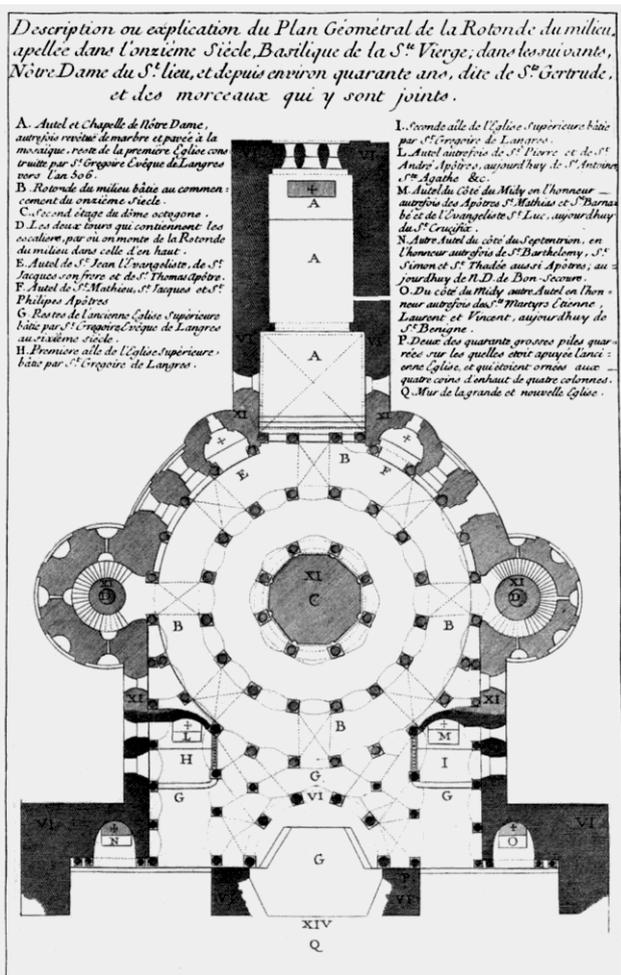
Grundriss des Rotundenmittelgeschosses (Dom PLANCHER 1739)
